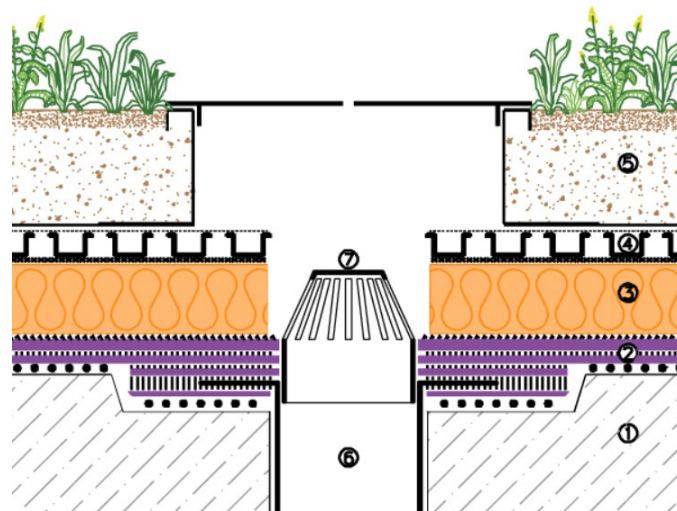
1 – залізобетонне покриття; 2 – гідроізоляція; 3 – теплоізоляція;
